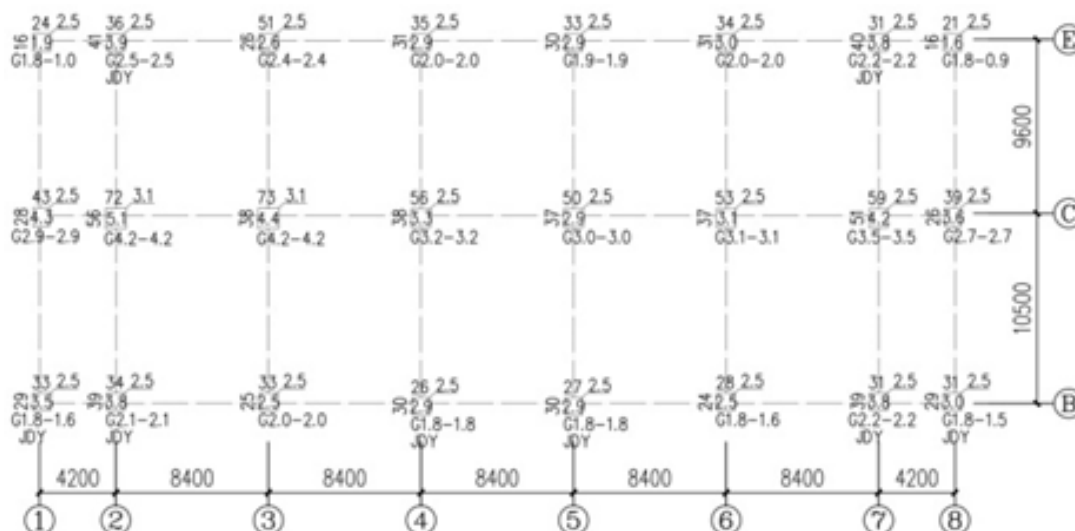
第 4 层混凝土构件配筋简图(单位:cm*cm)
